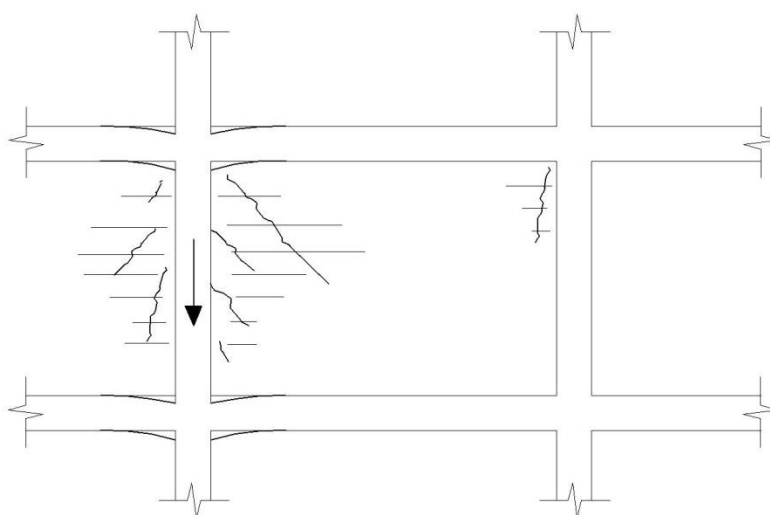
Fissuras em alvenaria devido a recalque diferencial das fundações
